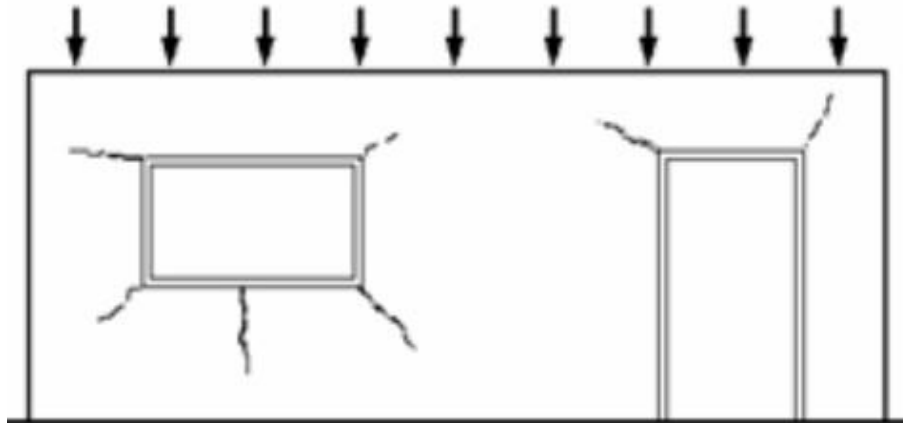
Fissuras horizontais provenientes de sobrecargas.
